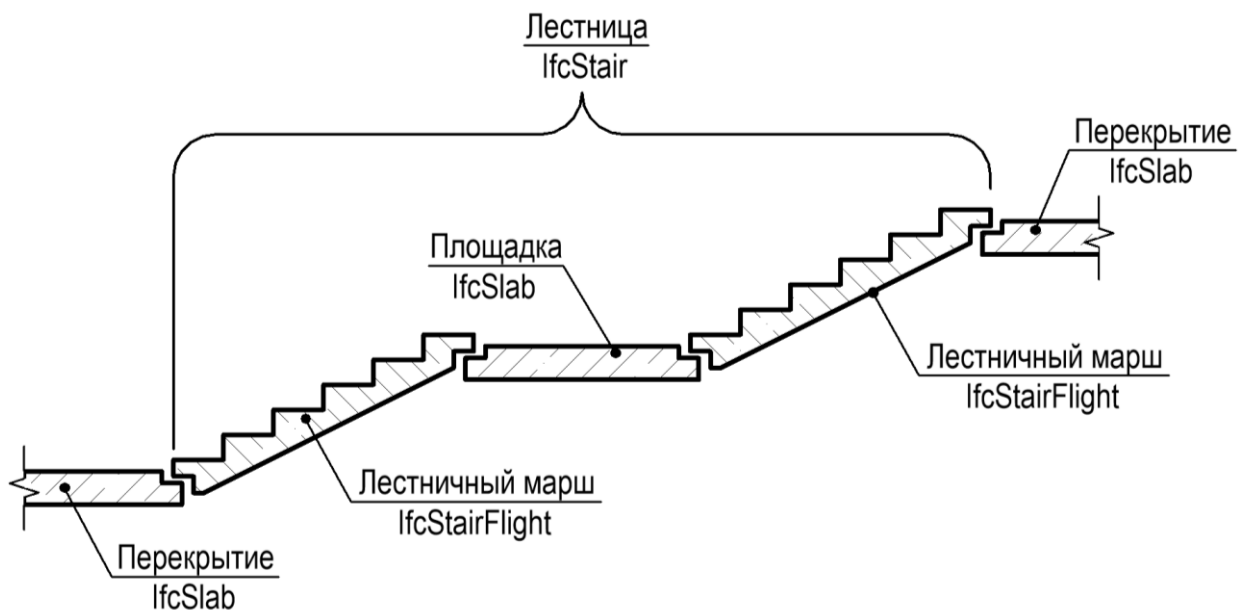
Пример моделирования сборных железобетонных лестниц
